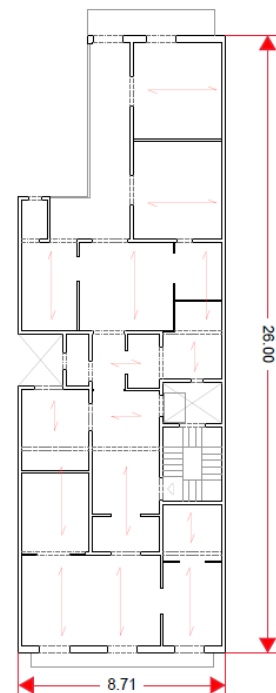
Plano estructural de la distribución en planta del edificio de la calle de Girona 65 extraído de Cornadó (2015)
